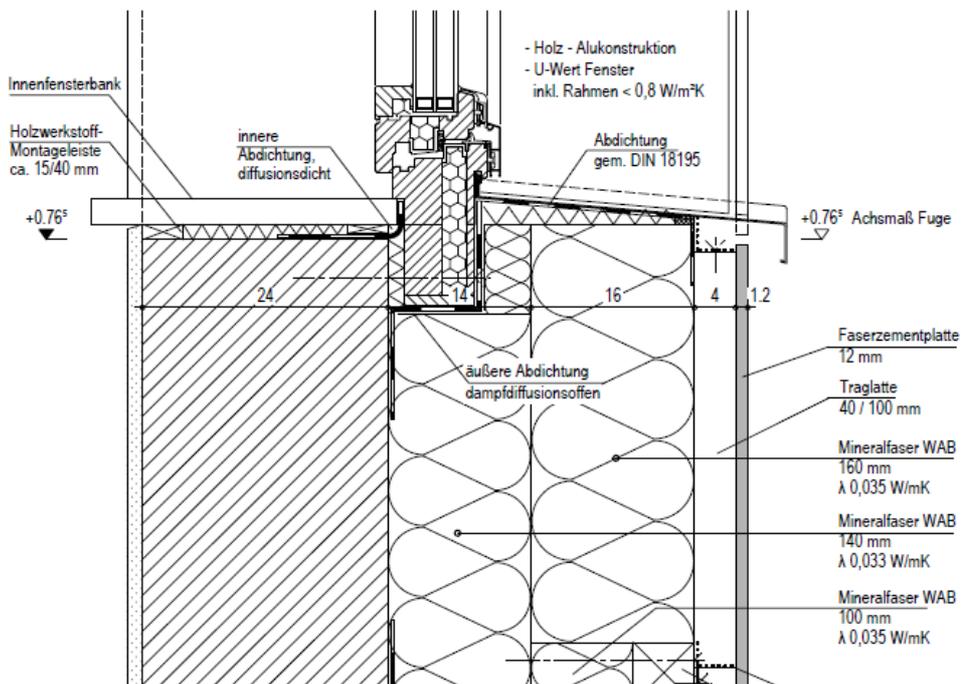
Einbau der Fenster an der Brüstung (Vertikalschnitt)
